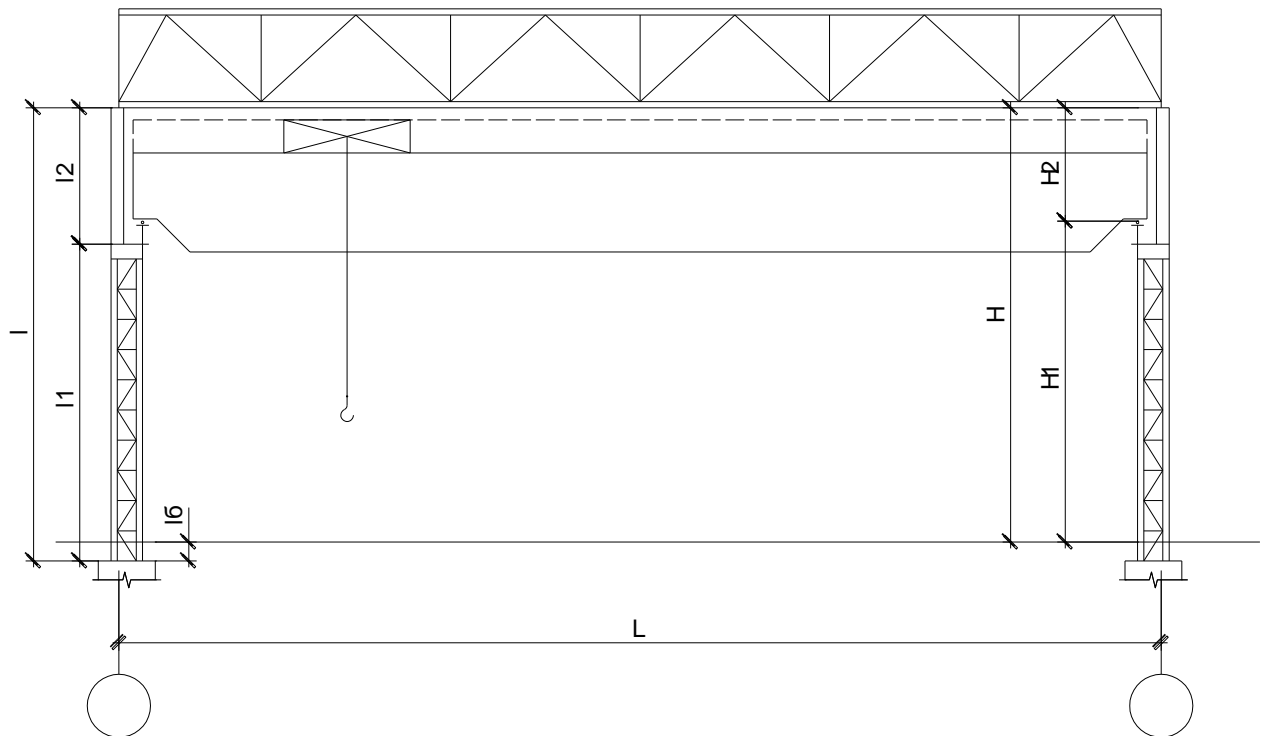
Поперечна рама металевого каркасу промислової будівлі
